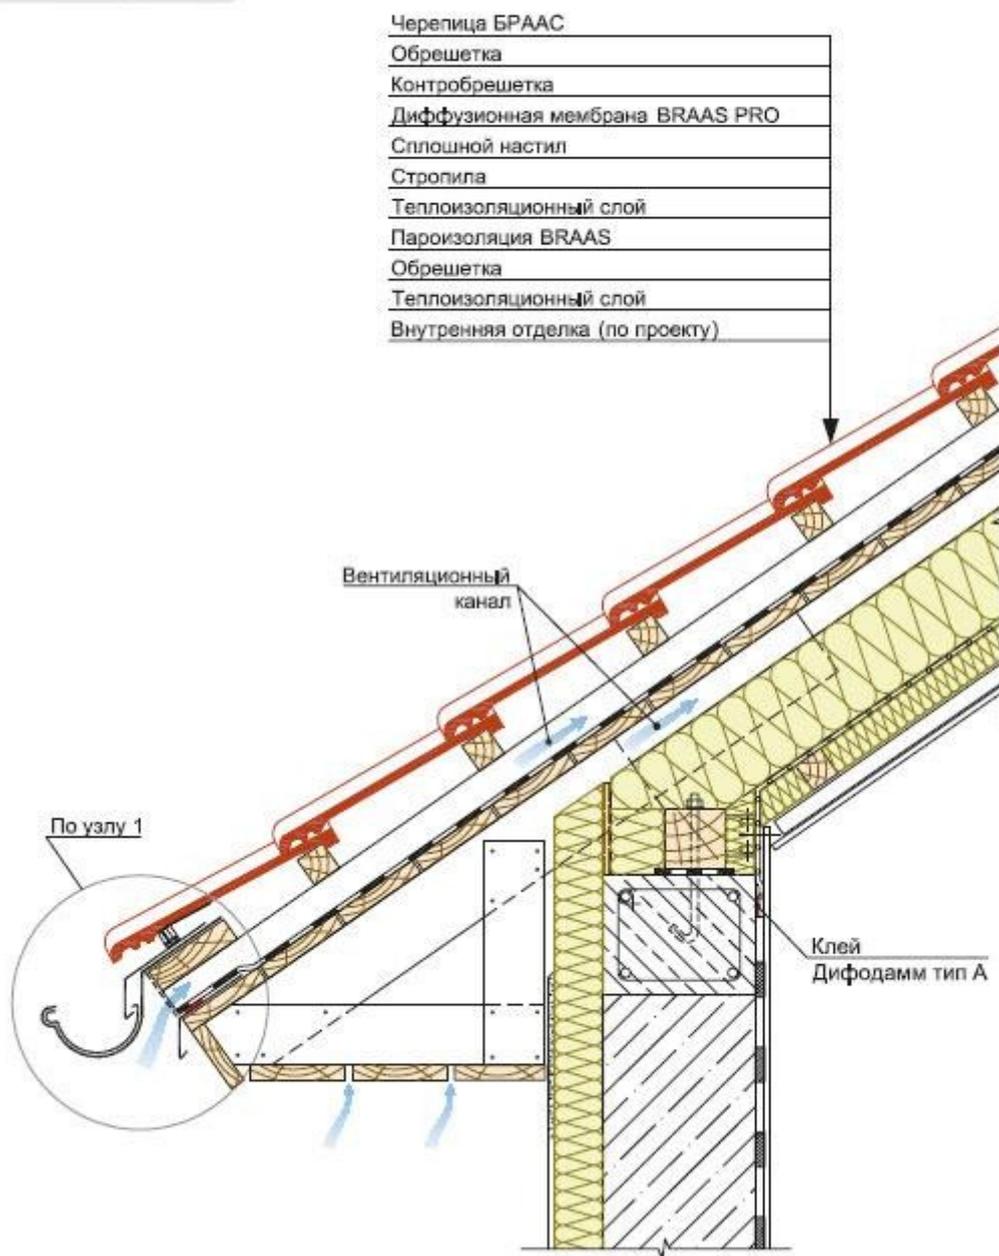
Узел карнизного свеса для утепленных кровель с рекомендуемыми и малыми уклонами со сплошным настилом, с двумя вентиляционными зазорами из альбома технических решений BMI BRAAS.
